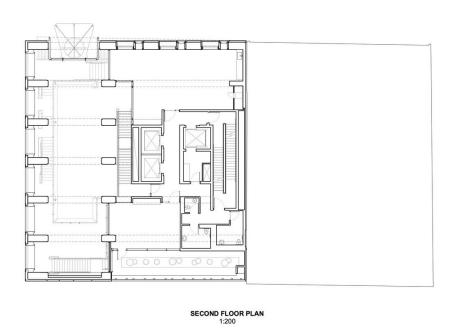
Planta baixa pavimento tipo Ace Hotel Toronto
